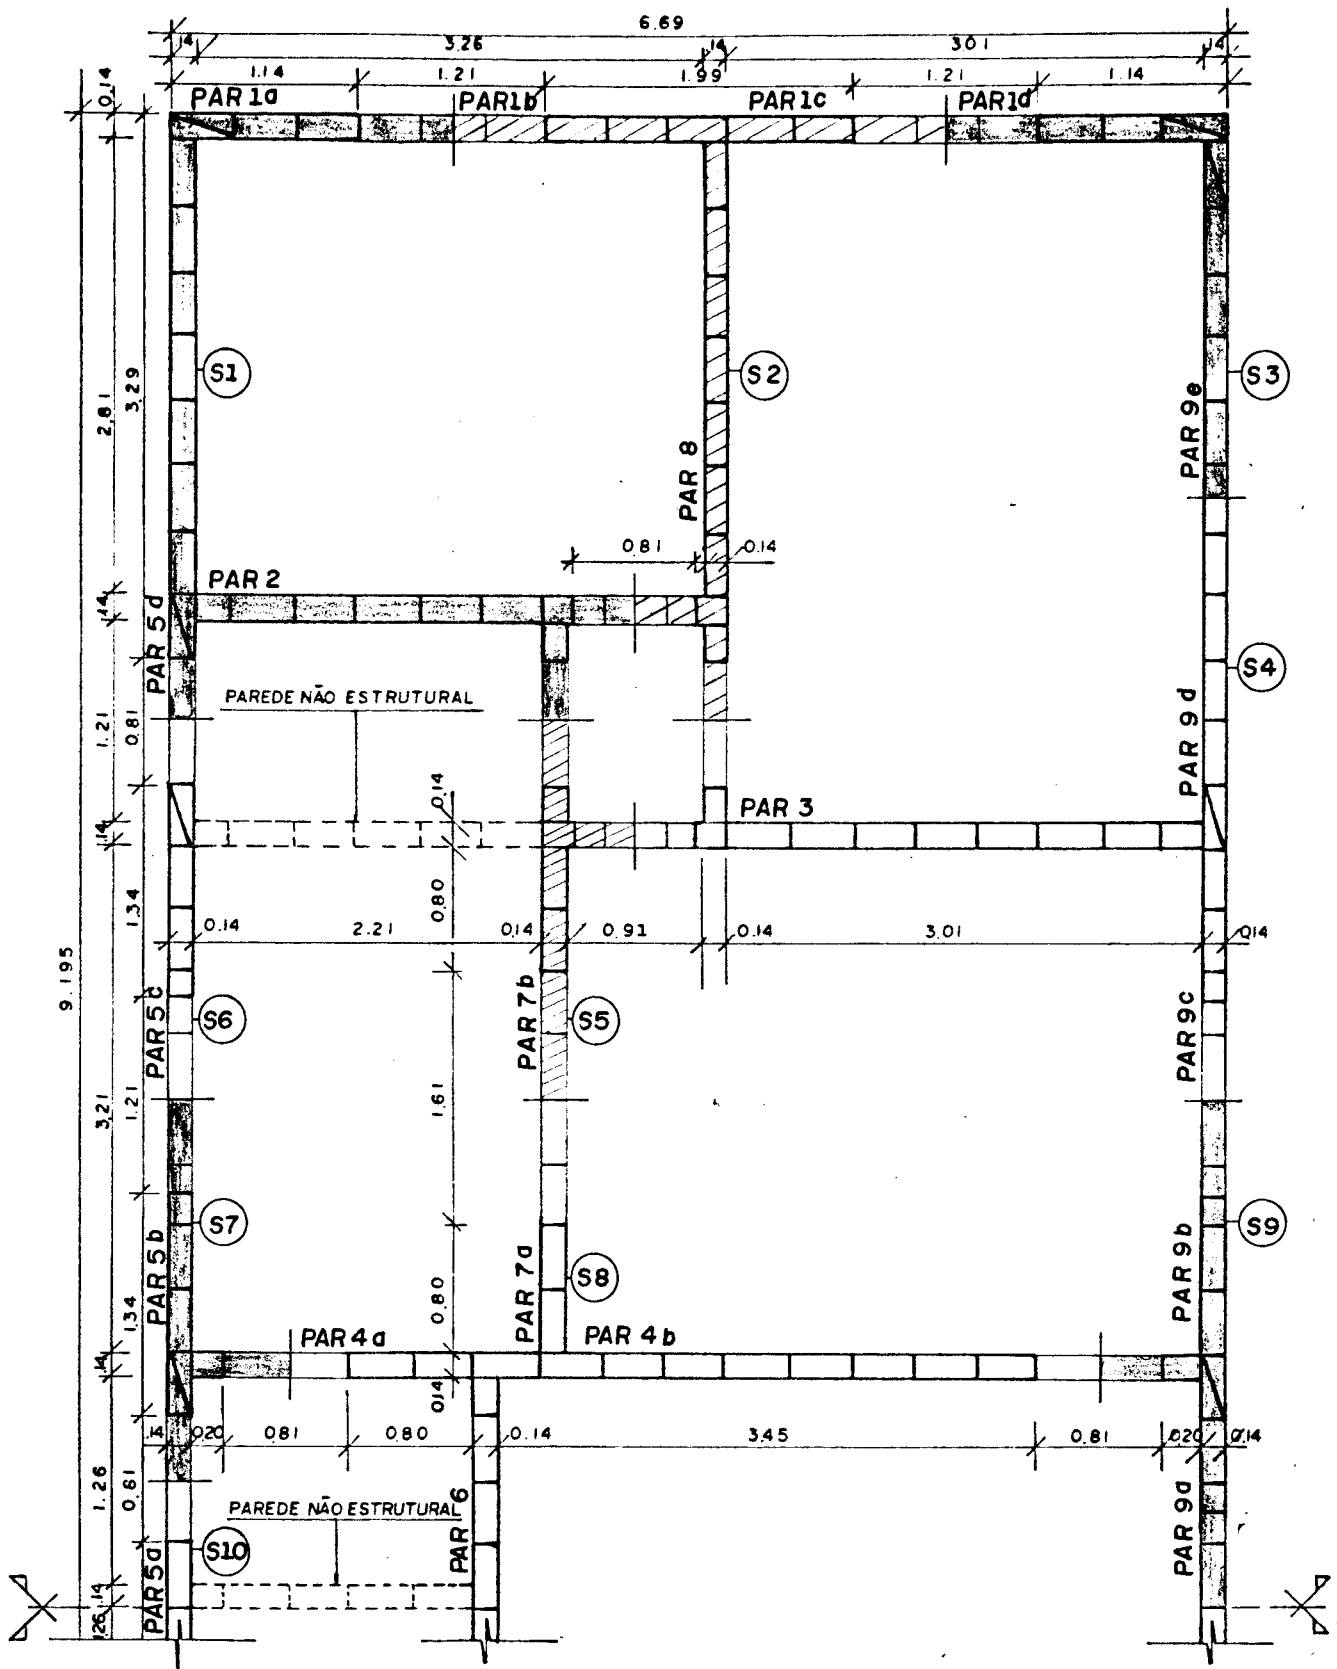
DIVISÃO DAS PAREDES EM SUB-ESTRUTURAS
